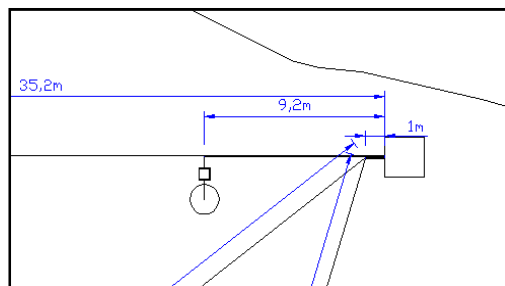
Detalle longitud conductores autocad. Alternativa 3.
